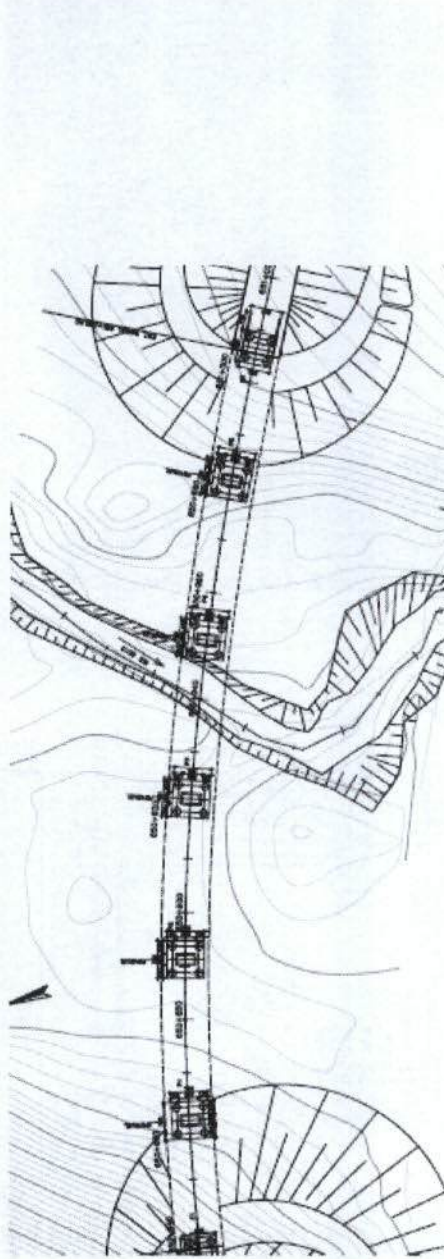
Projeto da ponte sobre o Rio Seco (planta de situação)
